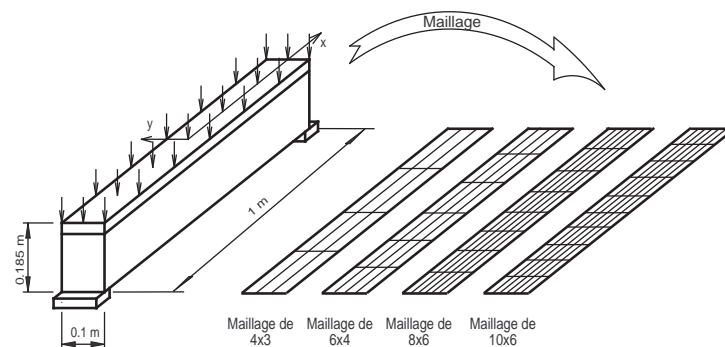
La poutre mixte en bois-béton considérée et son maillage 2D
